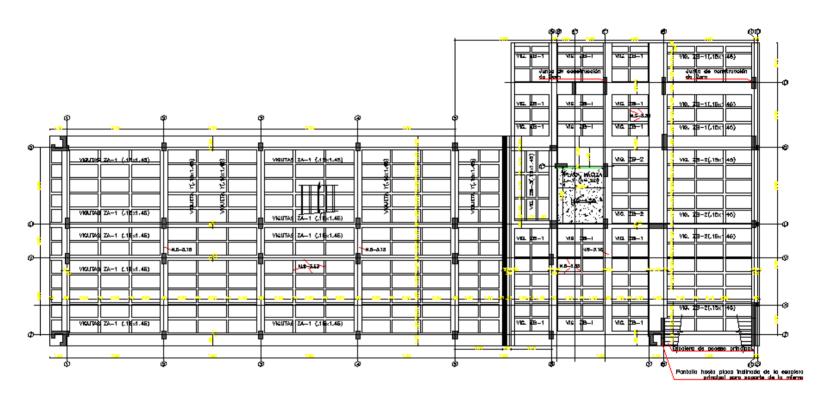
Cimentación de Estructuras 5 y 6 (Hotel y Gimnasio)
